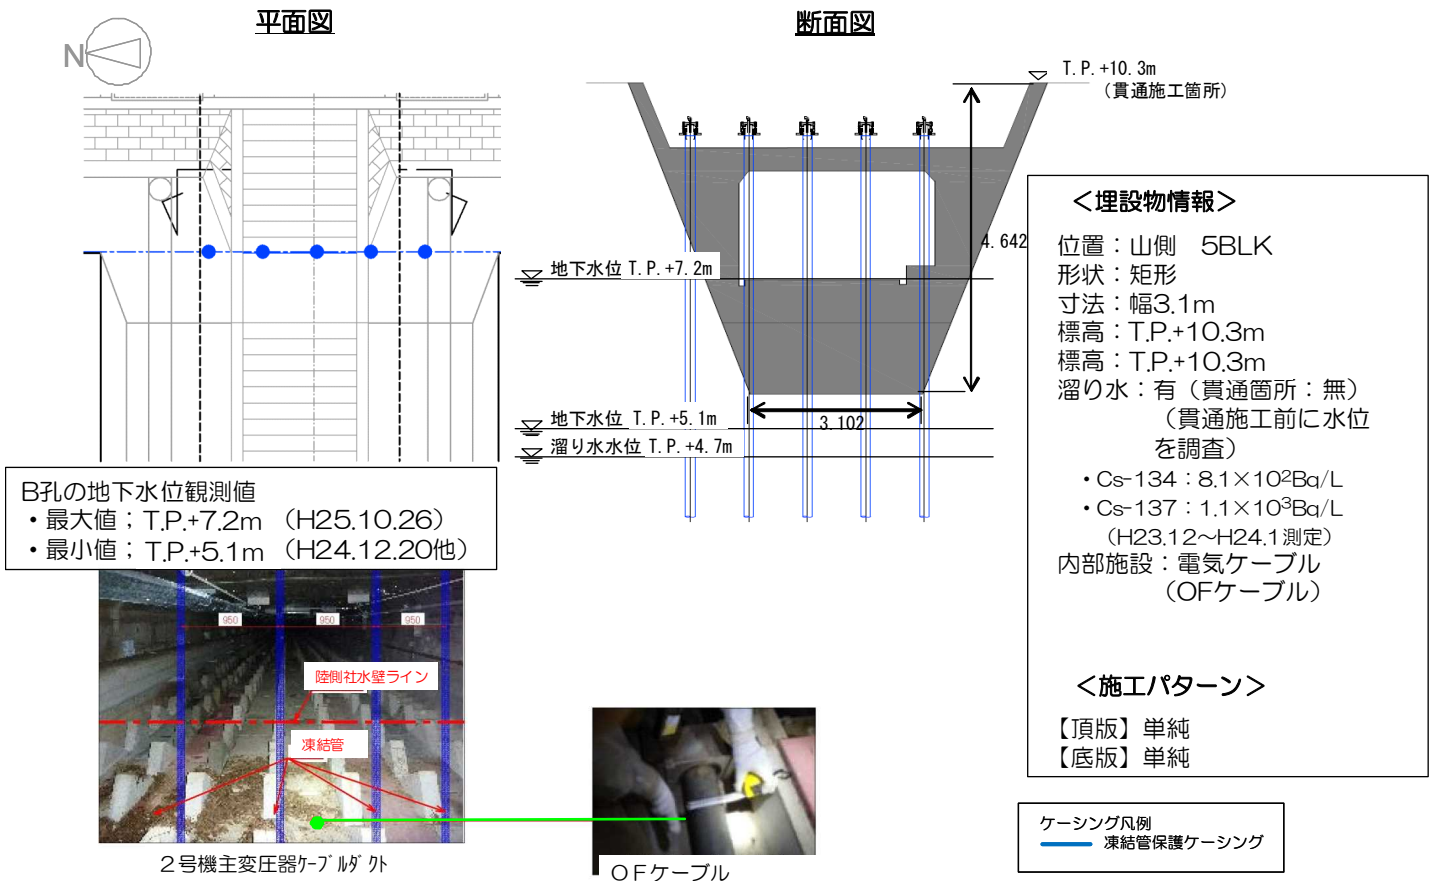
【5-1】1号機電気ケーブルダクト 施工方法 (貫通施工)
